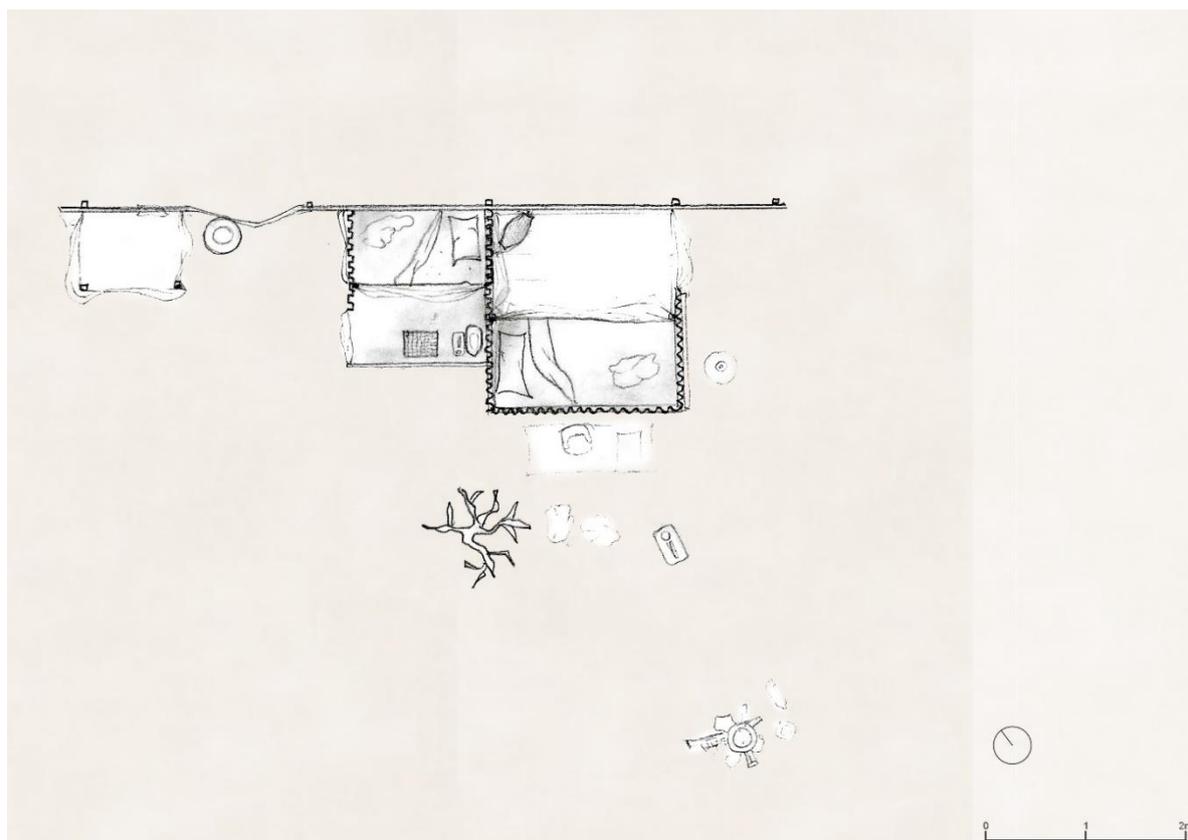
Planta da Casa 4. Levantado e desenhado pela Autora, em 2020.
